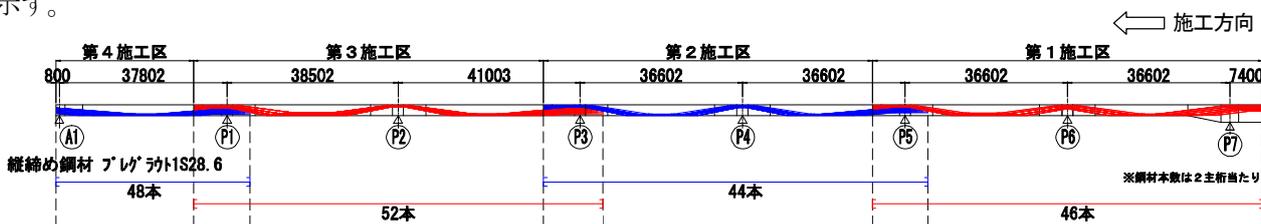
2主版桁部の施工区分およびPC鋼材配置概要図
